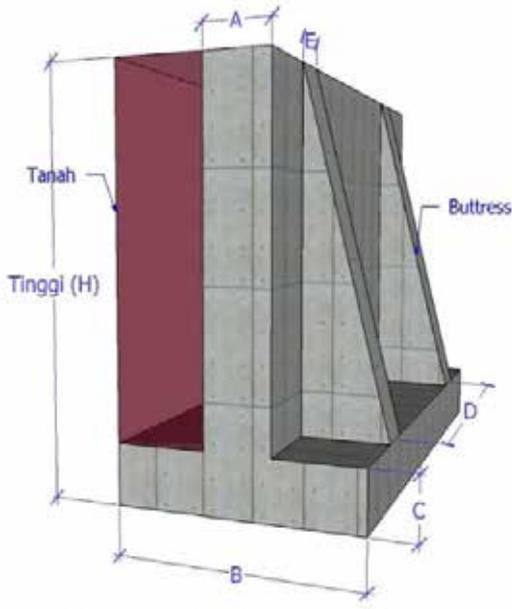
Different configuration for cantilever retaining wall (bawah)
